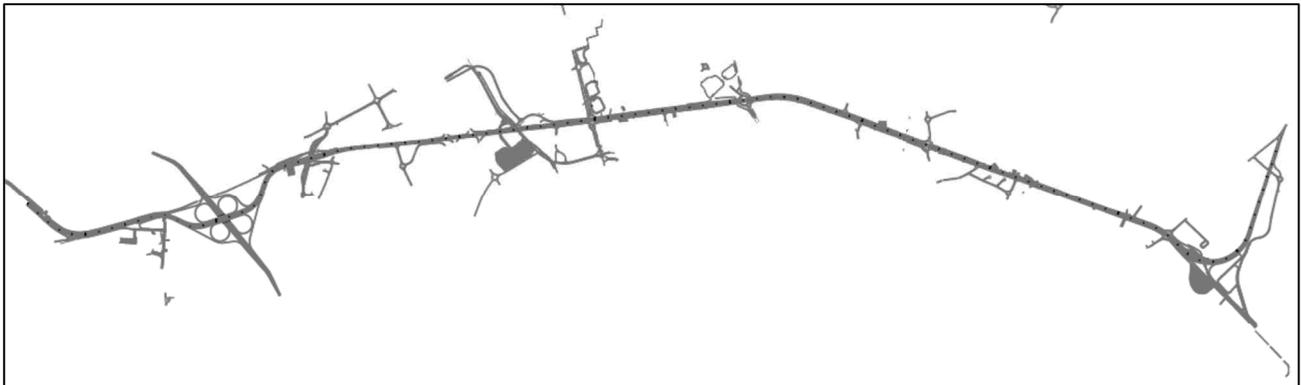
configurazione planimetrica dell'adeguamento della SS 554
